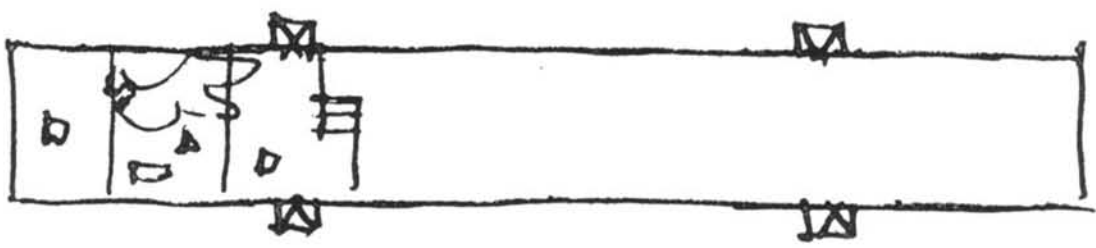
CROQUIS - PLANTAS/ CORTE/ FACHADA
